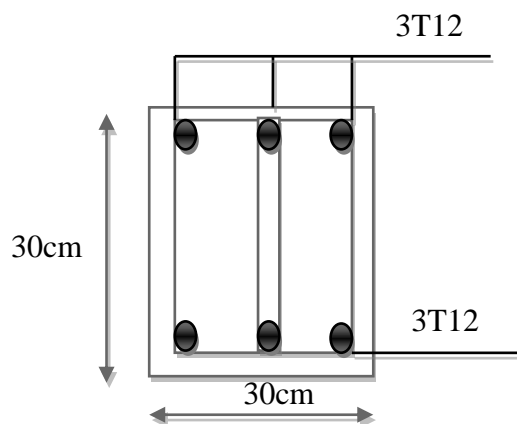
Ferrailage de la poutre secondaire en travée
